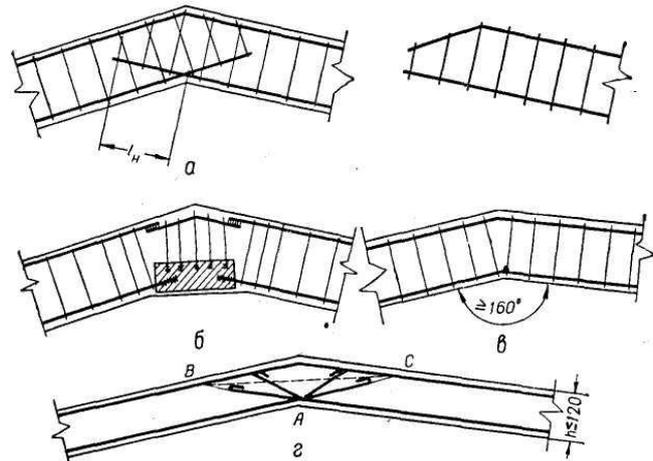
126. Армирование сварными каркасами и сетками входящих узлов железобетонных конструкций:
